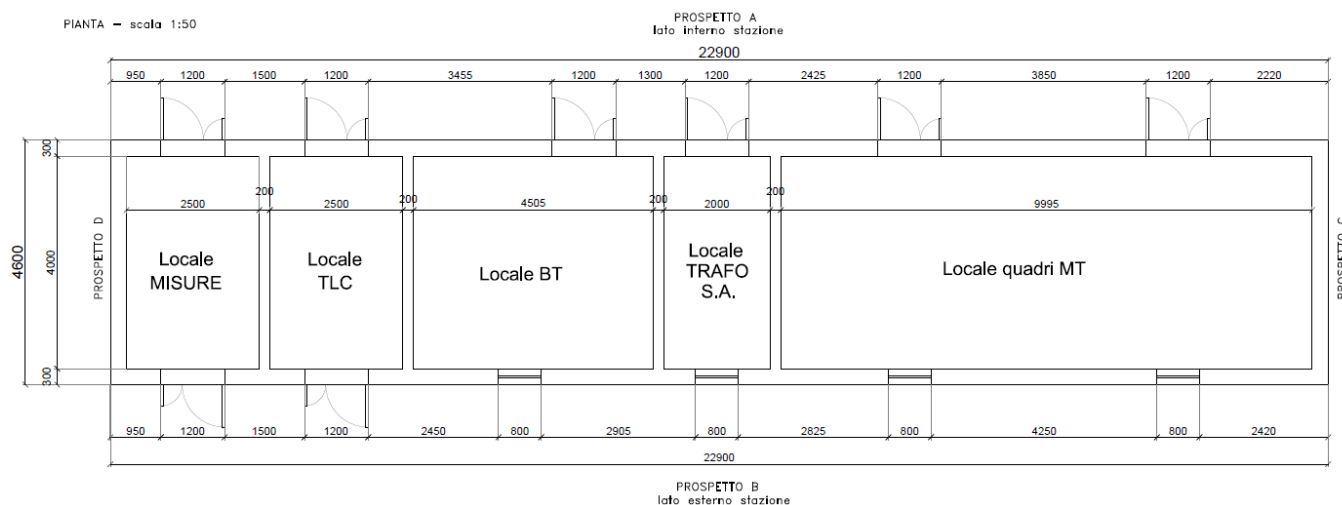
Piante edificio utente nella configurazione autorizzata con DD. n. 23AF.2016/D.00335
